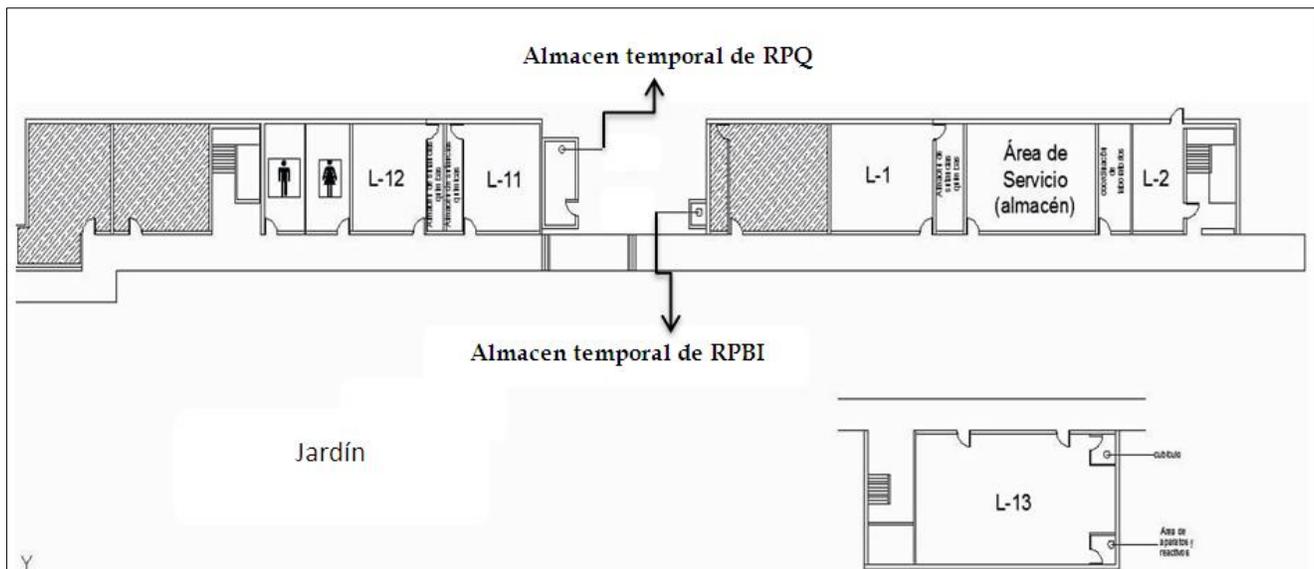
Edificios de laboratorios, planta baja. Fuente: Elaboración propia
